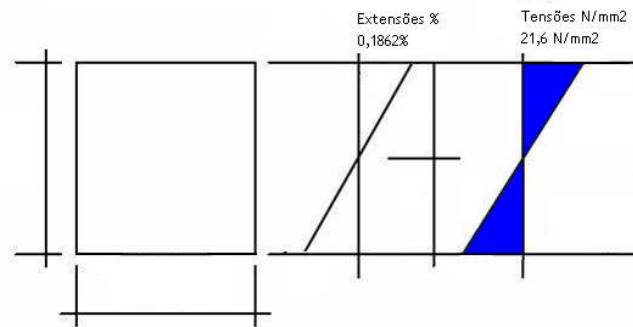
31 – Estado de tensão da viga para a colagem do laminado.
